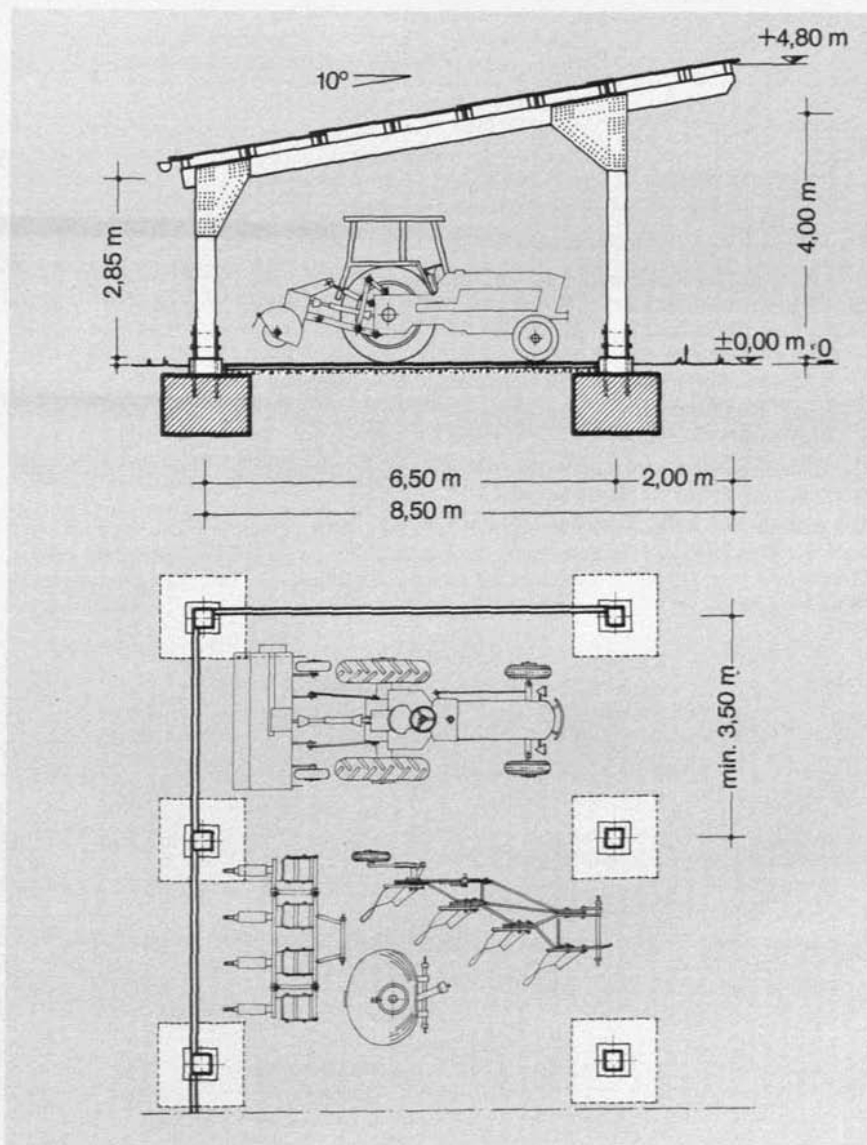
Pultdach-Maschinenhalle (Starrrahmenkonstruktion für den Selbstbau) (nach ALB)
